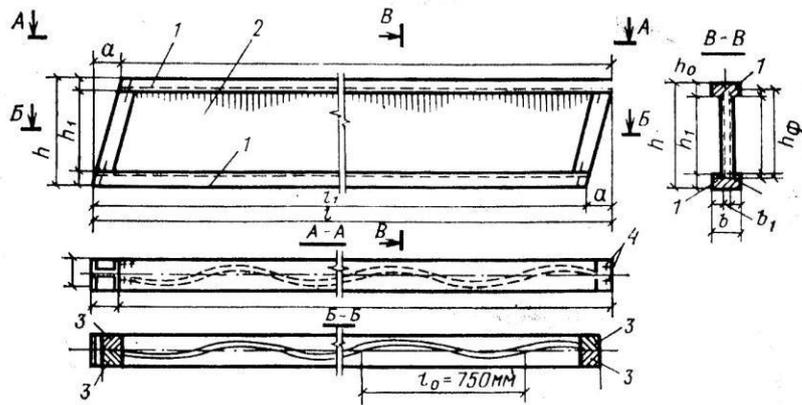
Деревянная клееная балка с волокнистой фанерной стенкой: 1 — доски или брусчатые верхний и нижний пояса; 2 — волнистая фанерная стенка; 3 — доски или брусчатые концевые элементы жесткости
